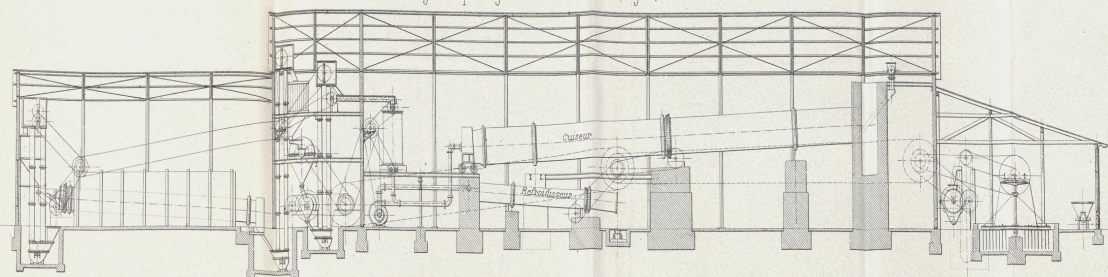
Coupe longitudinale suivant cd (Fig. 3)
